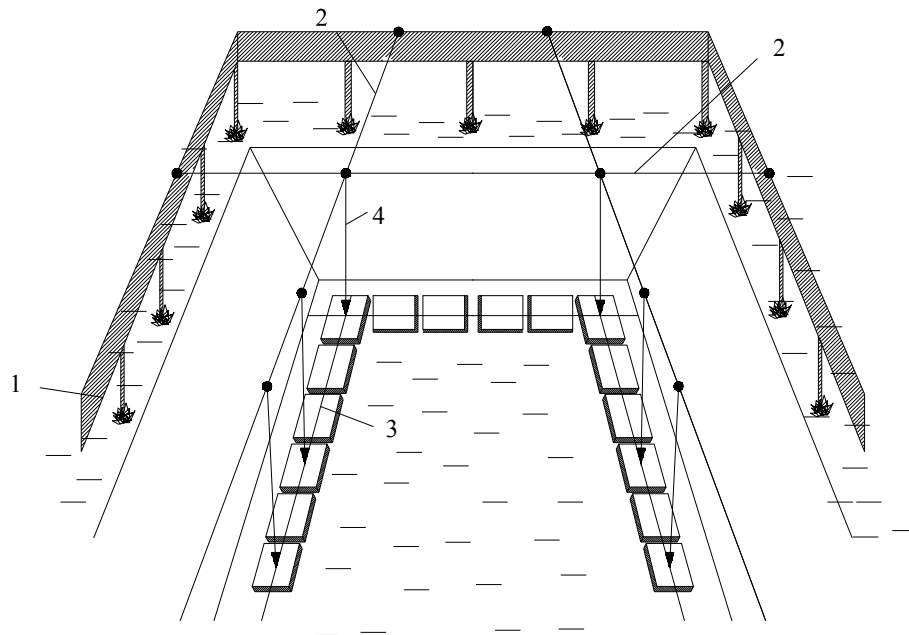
Монтаж блоків стрічкового фундаменту
